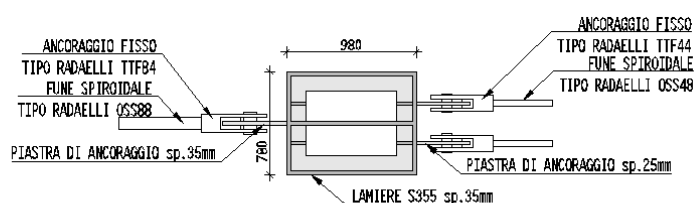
Sezioni tipo antenna in calcestruzzo e acciaio (quote in mm)
